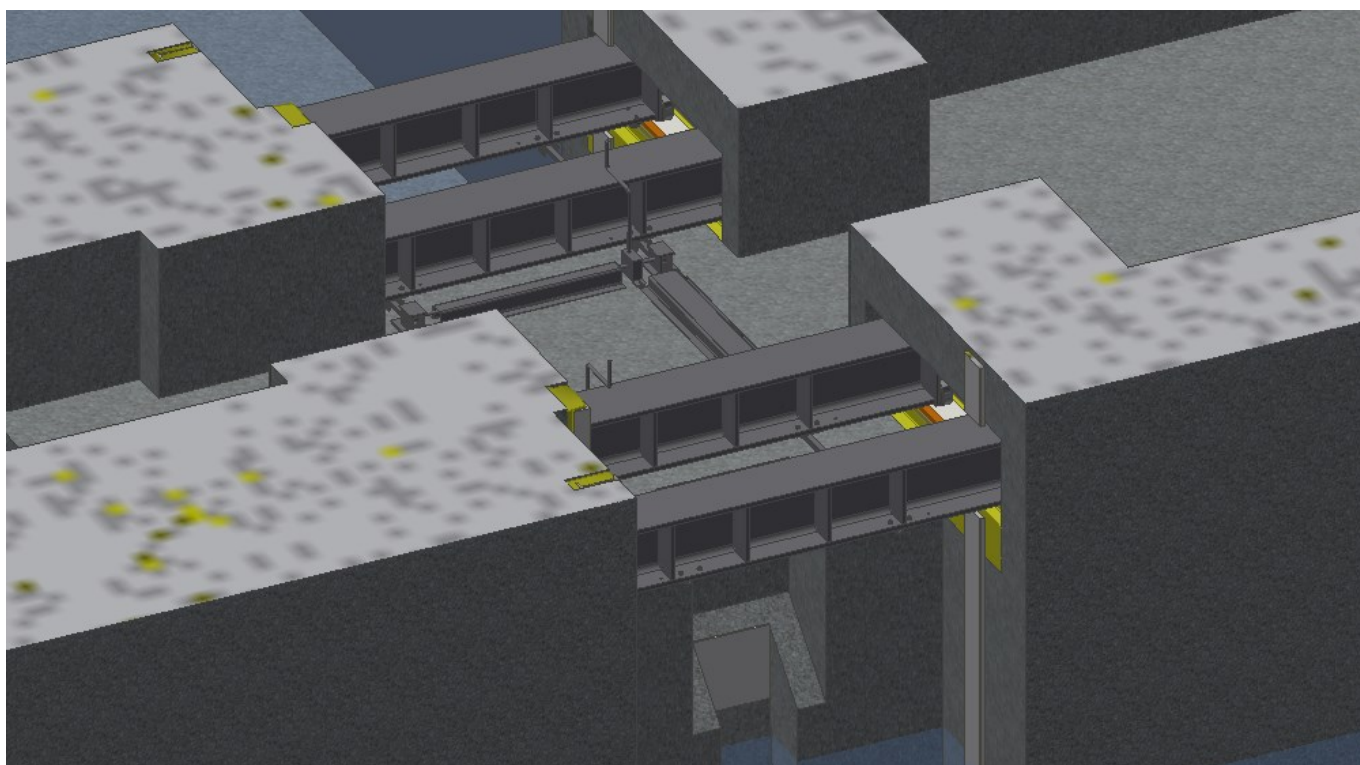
Implantation du dispositif dans la pile centrale, au niveau inférieur
